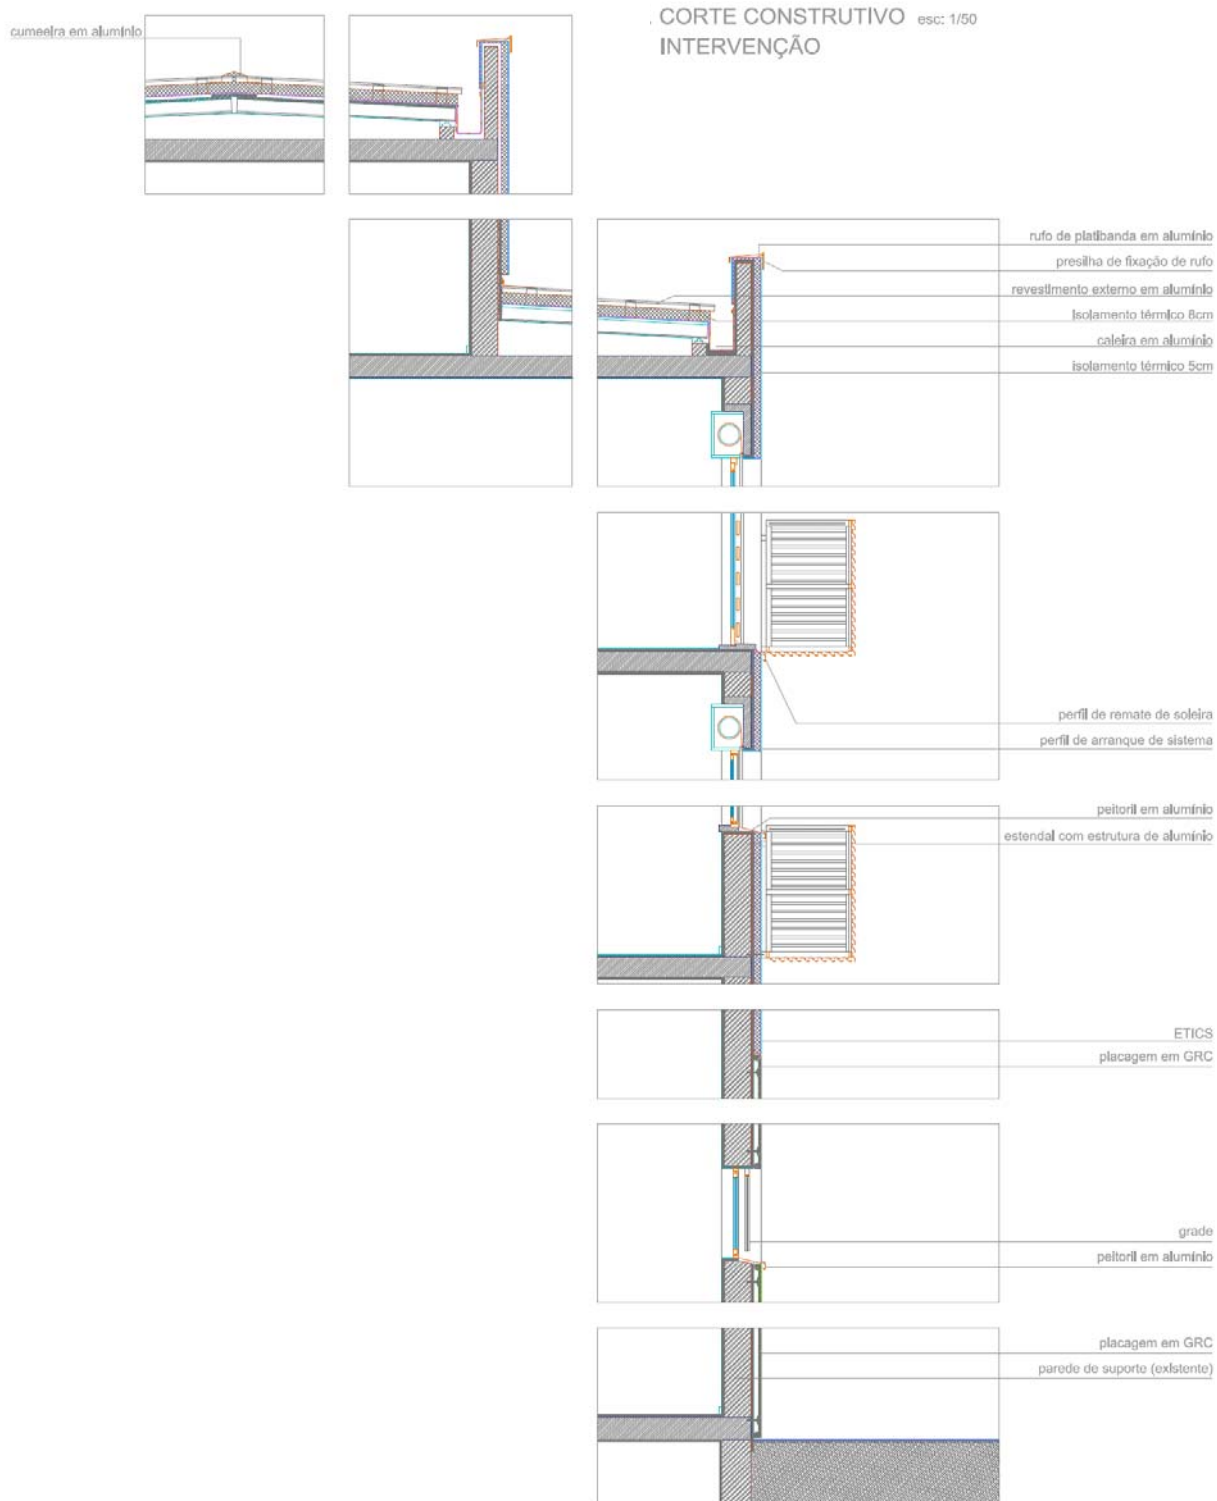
Intervenção proposta na fachada. Corte construtivo (escala 1/50).
